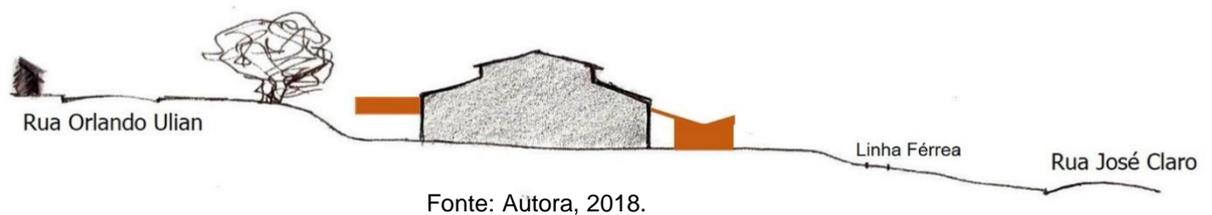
Elevação Longitudinal - IBC. Edificação original e intervenção.
